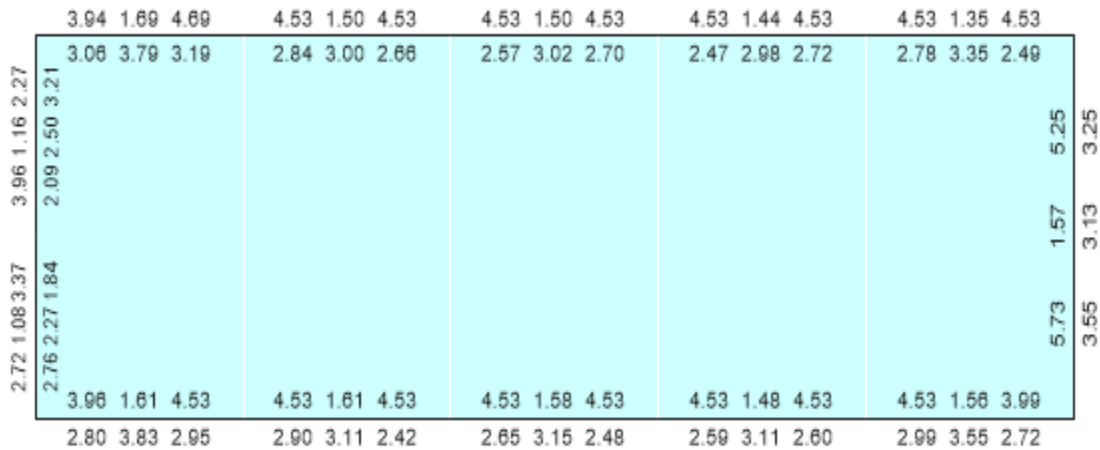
Refuerzo Longitudinal vigas en el modelo de restaurante. Piso 1 N+6.50. Cm2
